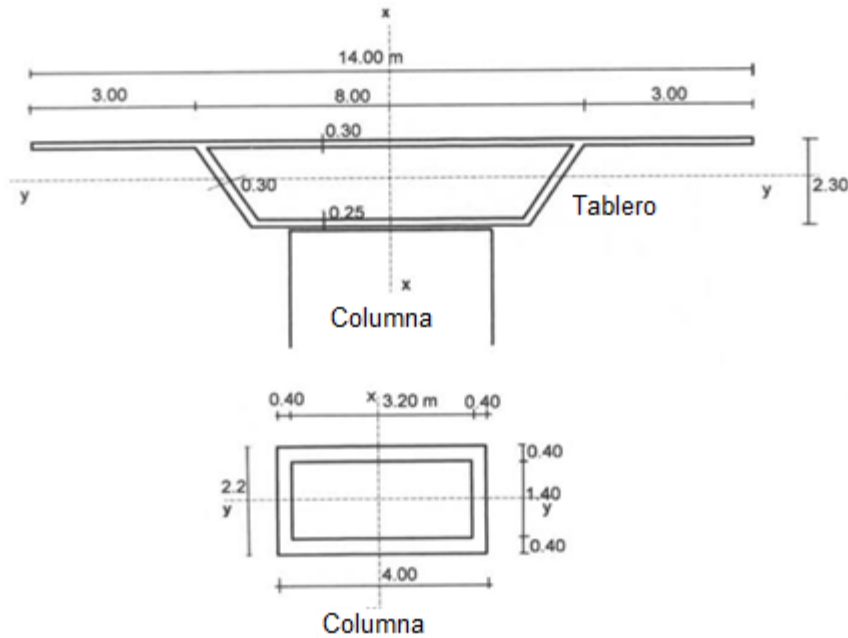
Dimensiones de vigas y columnas (Priestley et al., 1996).
